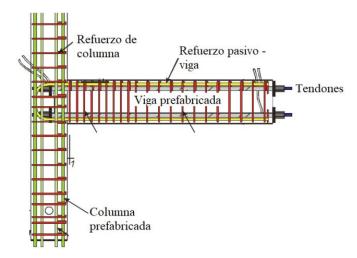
Conexión viga post-tensada entre columnas. Fuente: (Bedriñana, 2021)
